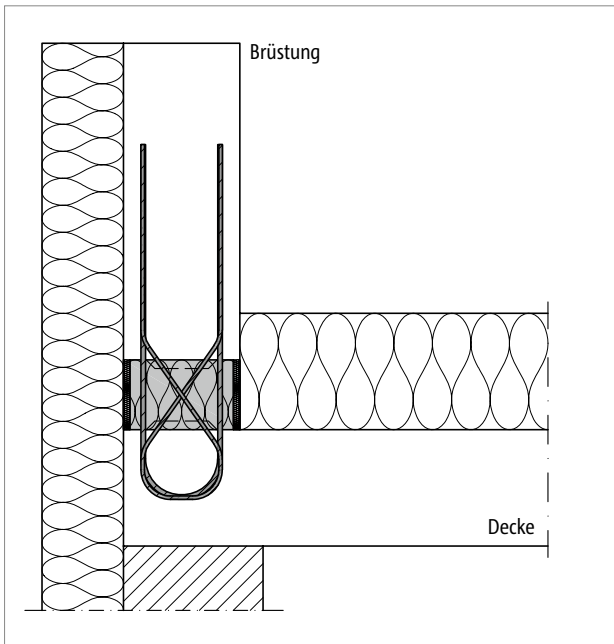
Schöck Isokorb® XT/T Typ AP vertikale Anordnung: Anschluss einer aufgesetzten Brüstung
